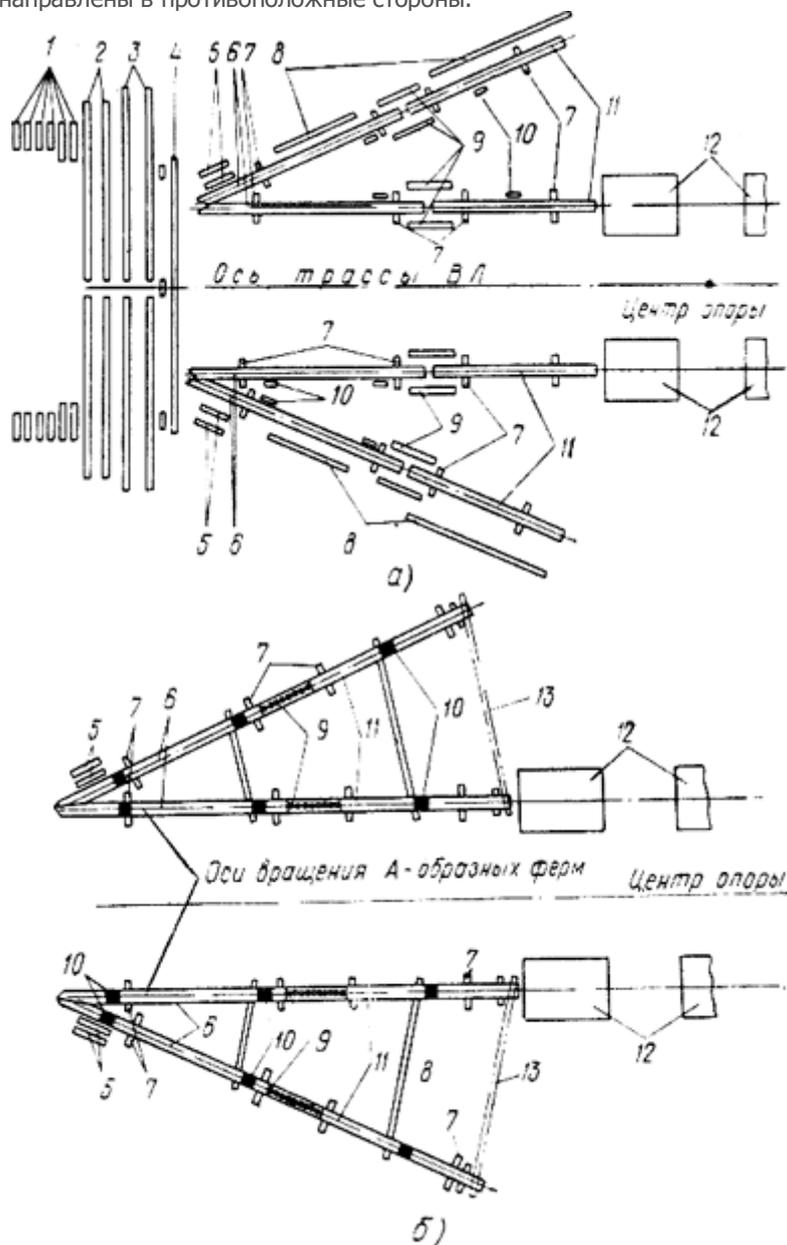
Выкладка деталей (а) и сборка А - образных ферм (б) АП - образных опор:
